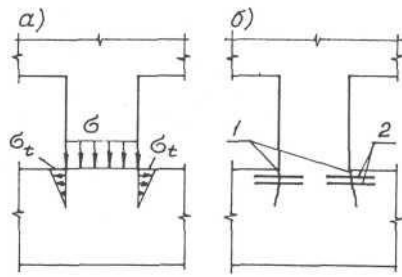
(1 — трещины, 2 — арматура)
